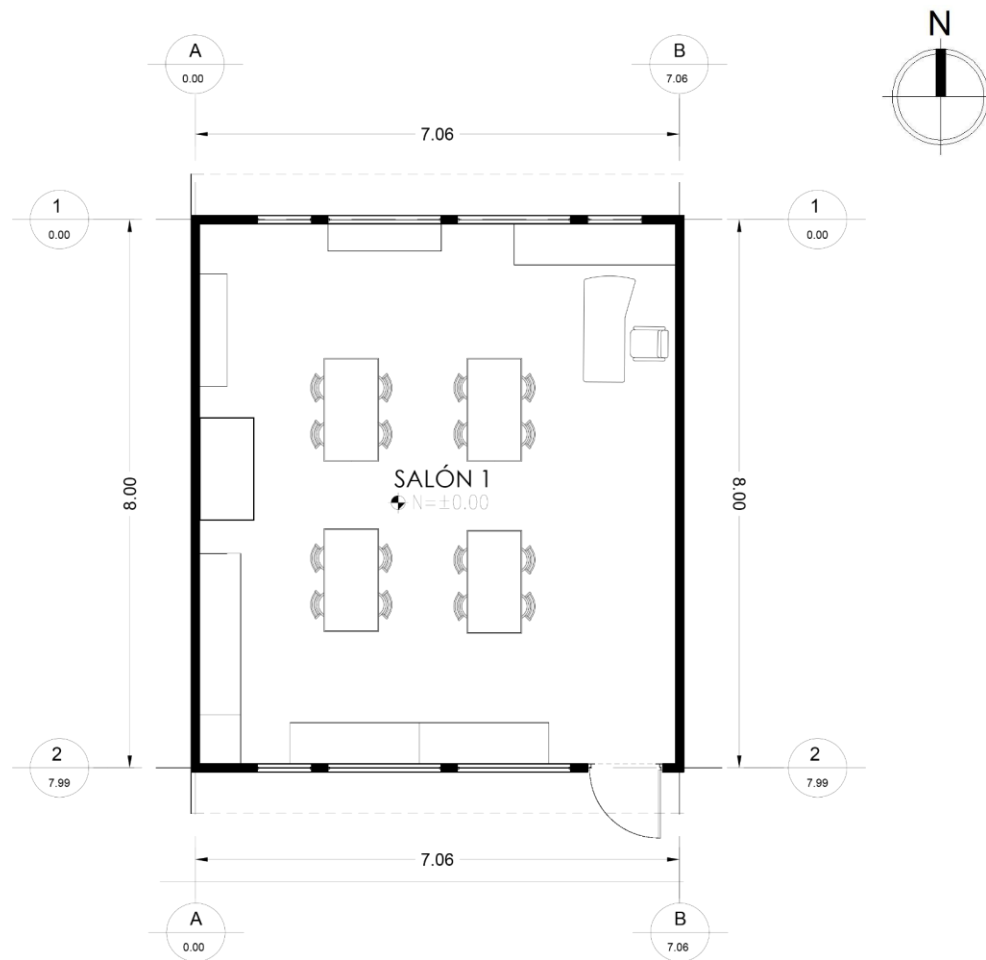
Imagen ilustrativa de plano de planta arquitectónica de Preescolar B.
